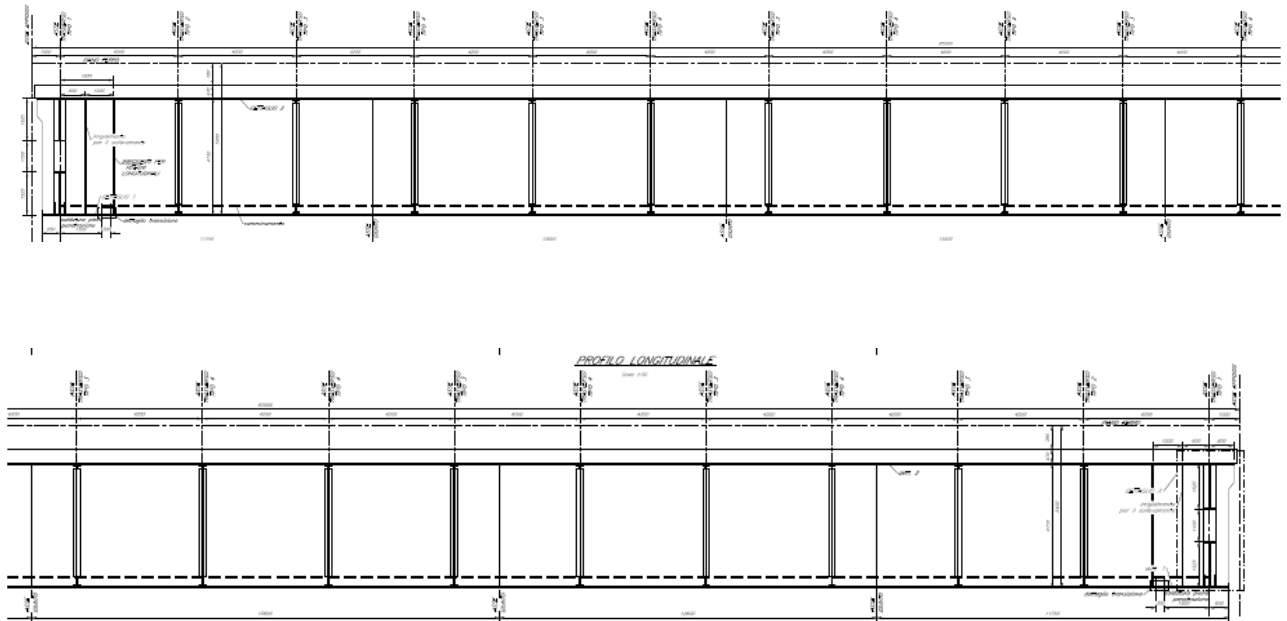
Profilo longitudinale dell'impalcato (1/2 impalcato, simmetrico rispetto alla mezzeria)
